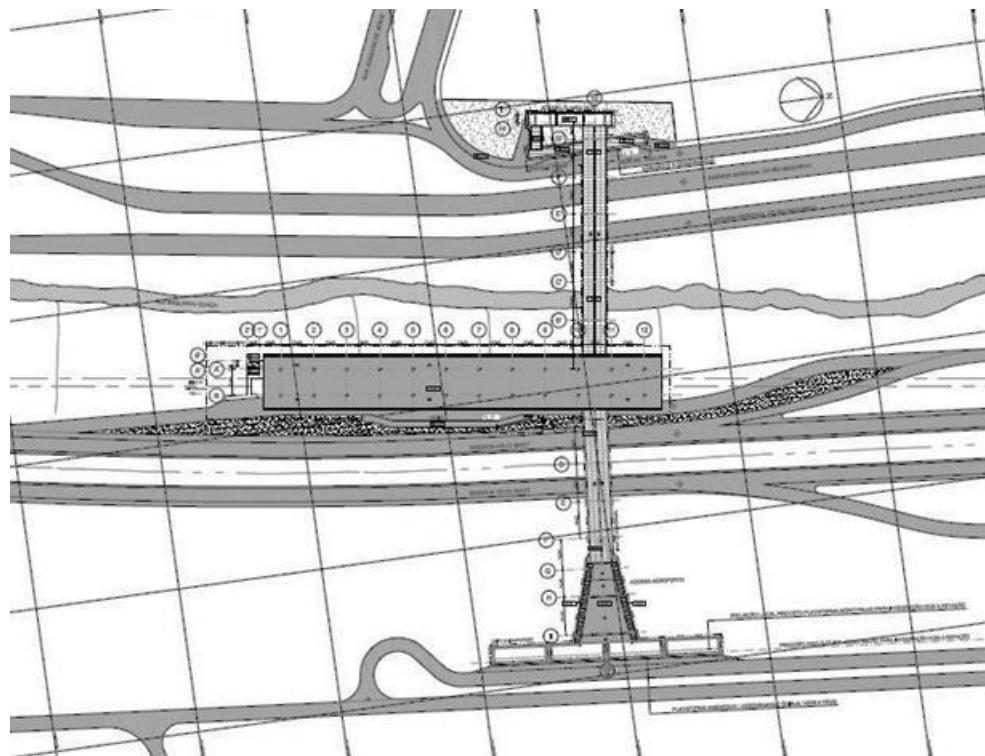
Planta Geral de Implantação - Estação Aeroporto - Guarulhos (CPTM, 2013)
